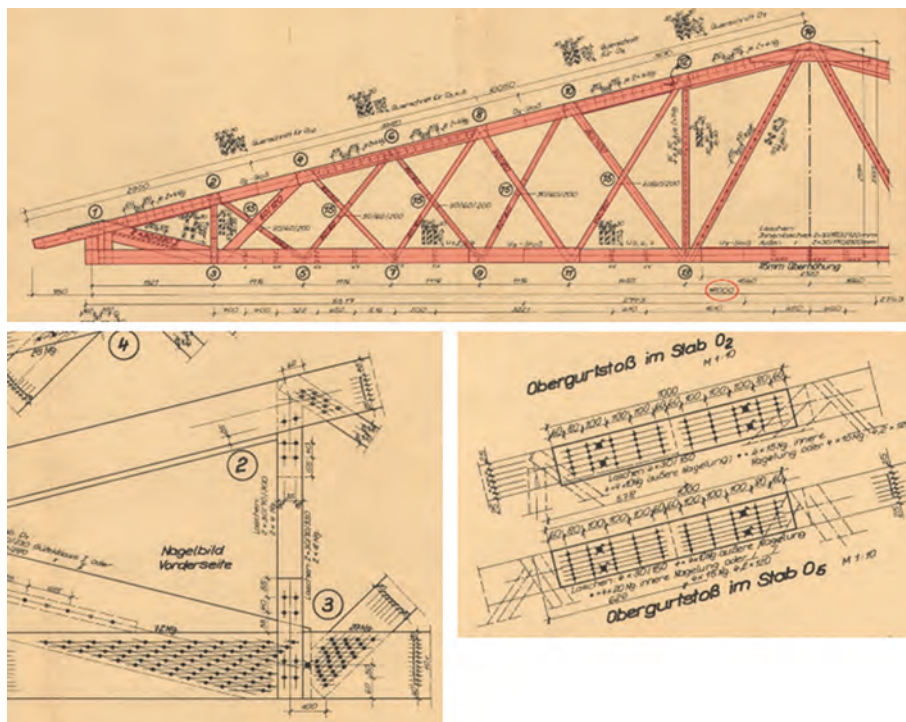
Institut für Bauelemente und Faserbaustoffe Leipzig: Konstruktionszeichnungen Typ BS 148.1, 1972 (Archiv V. Mund, Weimar)
